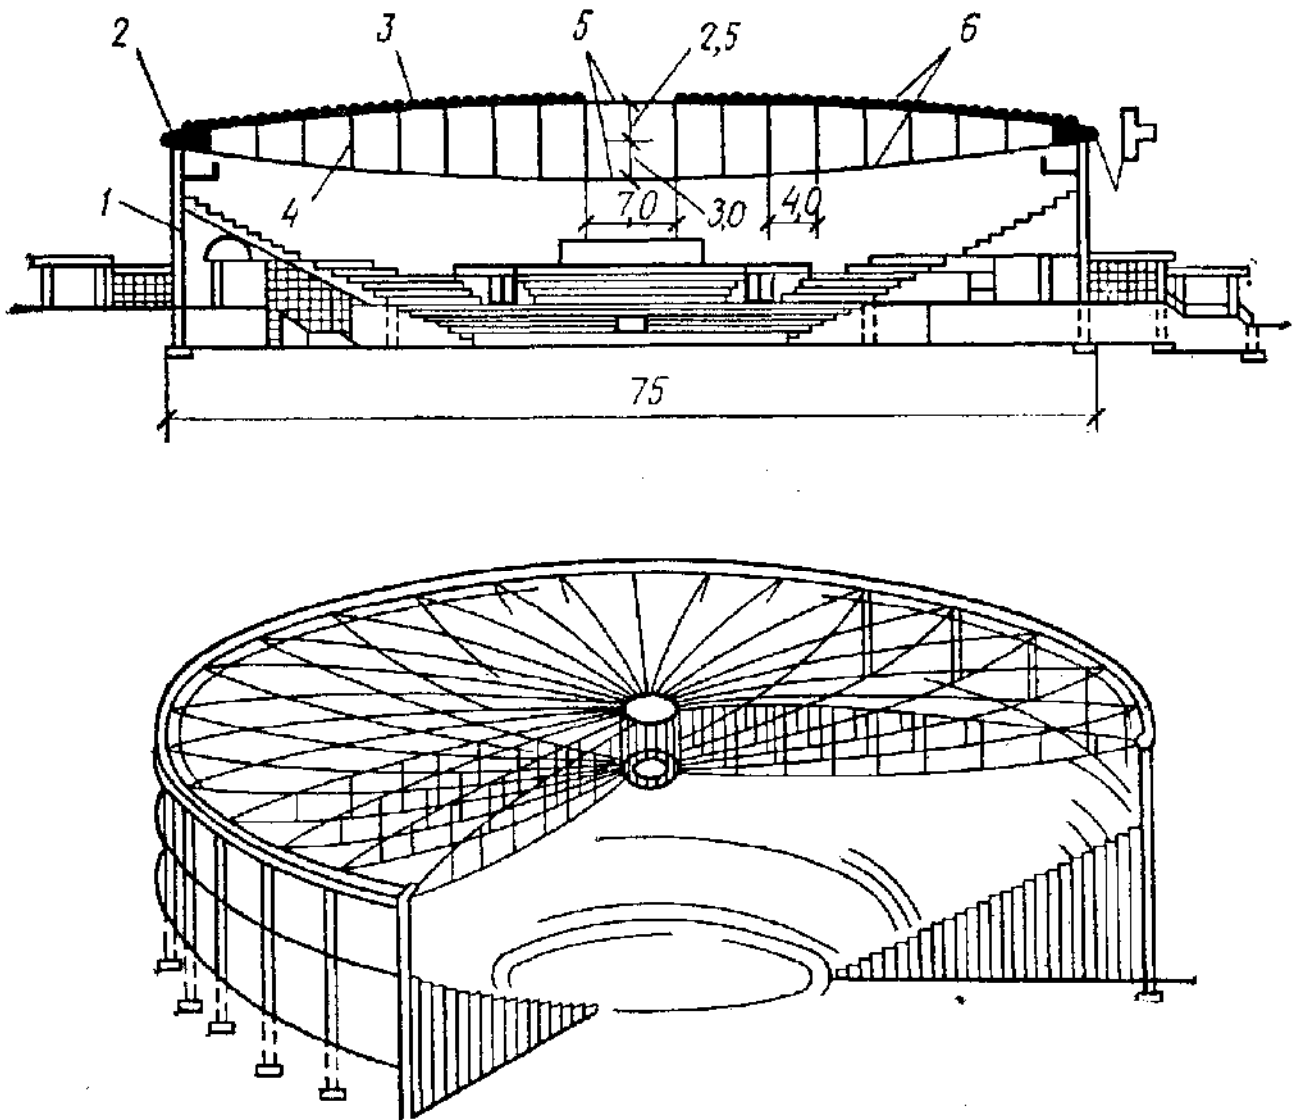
Покрытие аудитории в г. Утике (США): 1 – железобетонная колонна;
